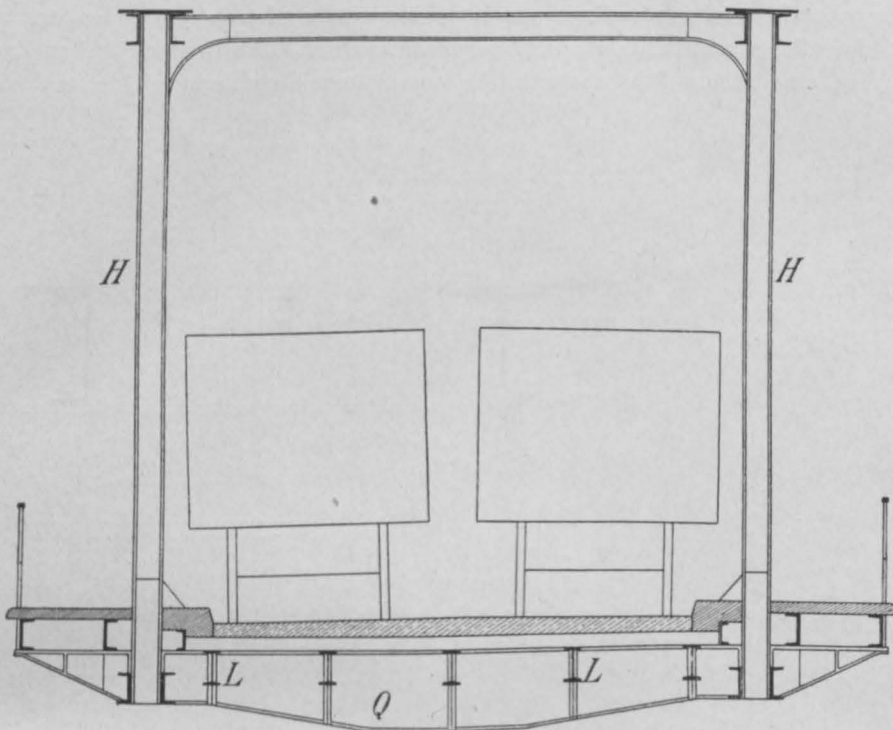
Querschnitt des Haupttragwerkes mit der Fahrbahn.
